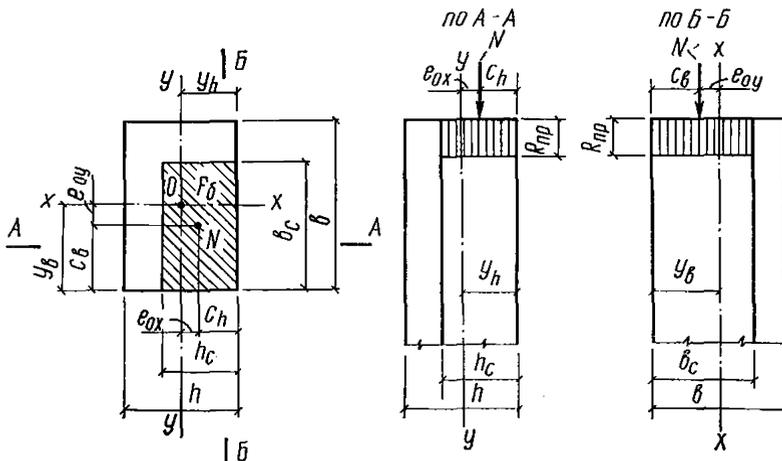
Схема расположения усилий и эпюра напряжений в поперечном сечении бетонного элемента при косом внецентренном сжатии.
